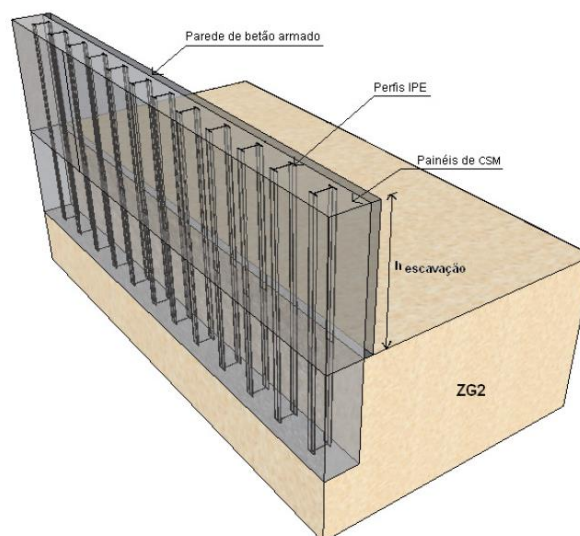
Aspeto tridimensional da solução estrutural adotada (Sousa, 2009)
